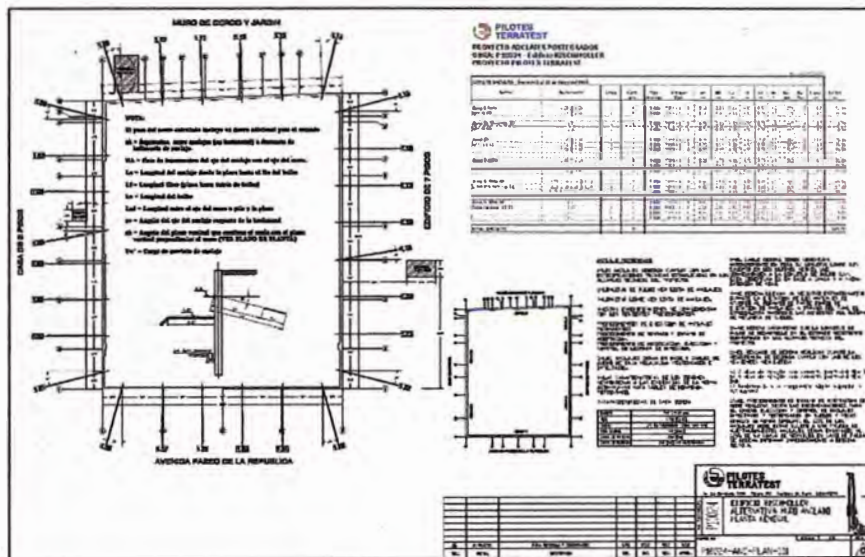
Plano en planta de distribución de anclajes<sup>16</sup>
